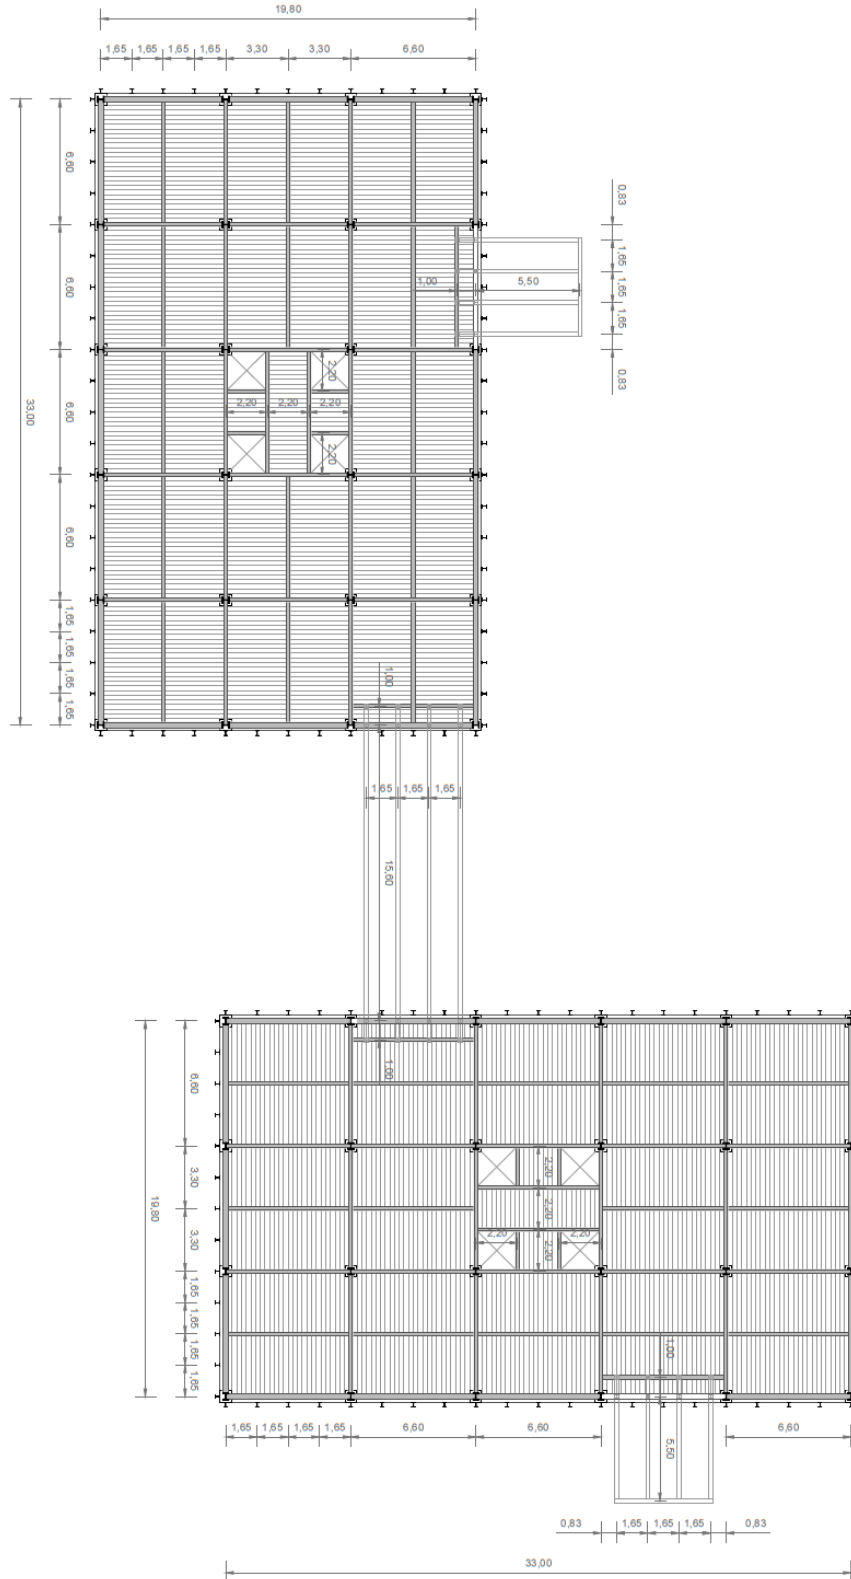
Planta estructural del forjado de planta baja. Escala 1:400
